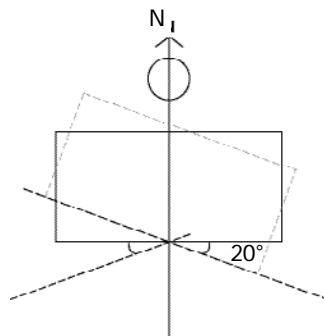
Ángulo de inclinación recomendada para reducir las ganancias de calor en las fachadas este y oeste
